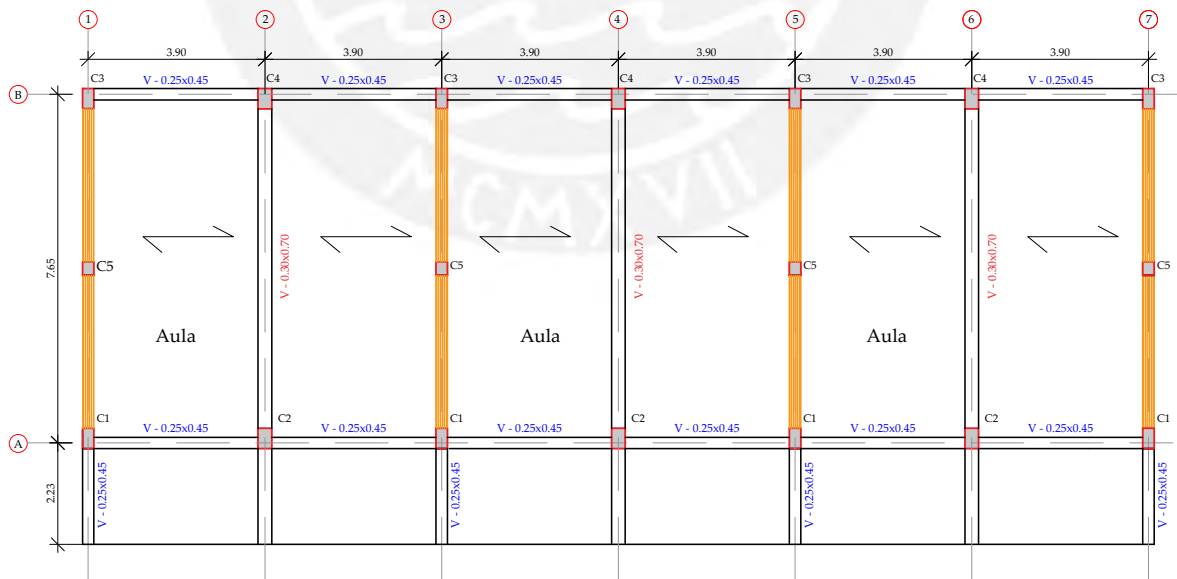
Esquema general del sistema estructural para un edificio escolar 780 – Pre, de 3 aulas
